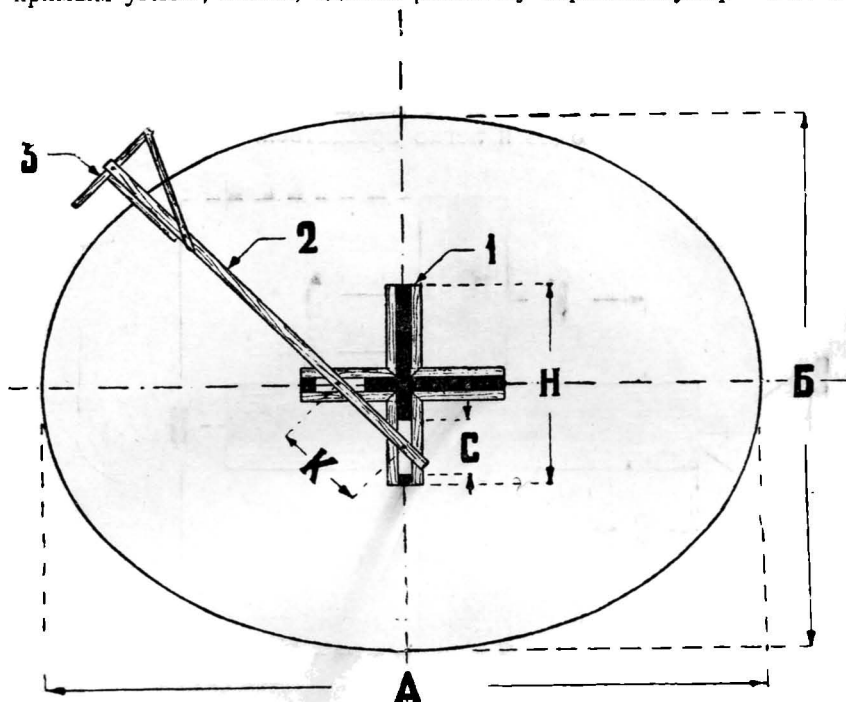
Схема расположения крестовины и шаблона для вытягивания эллипсовых тяг. 1 — крестовина, 2 — рычаг, соединяющий шаблон, с движками, 3 — шаблон, Н — величина крестовины, К — расстояние между центрами фокусов, С — длина движка
